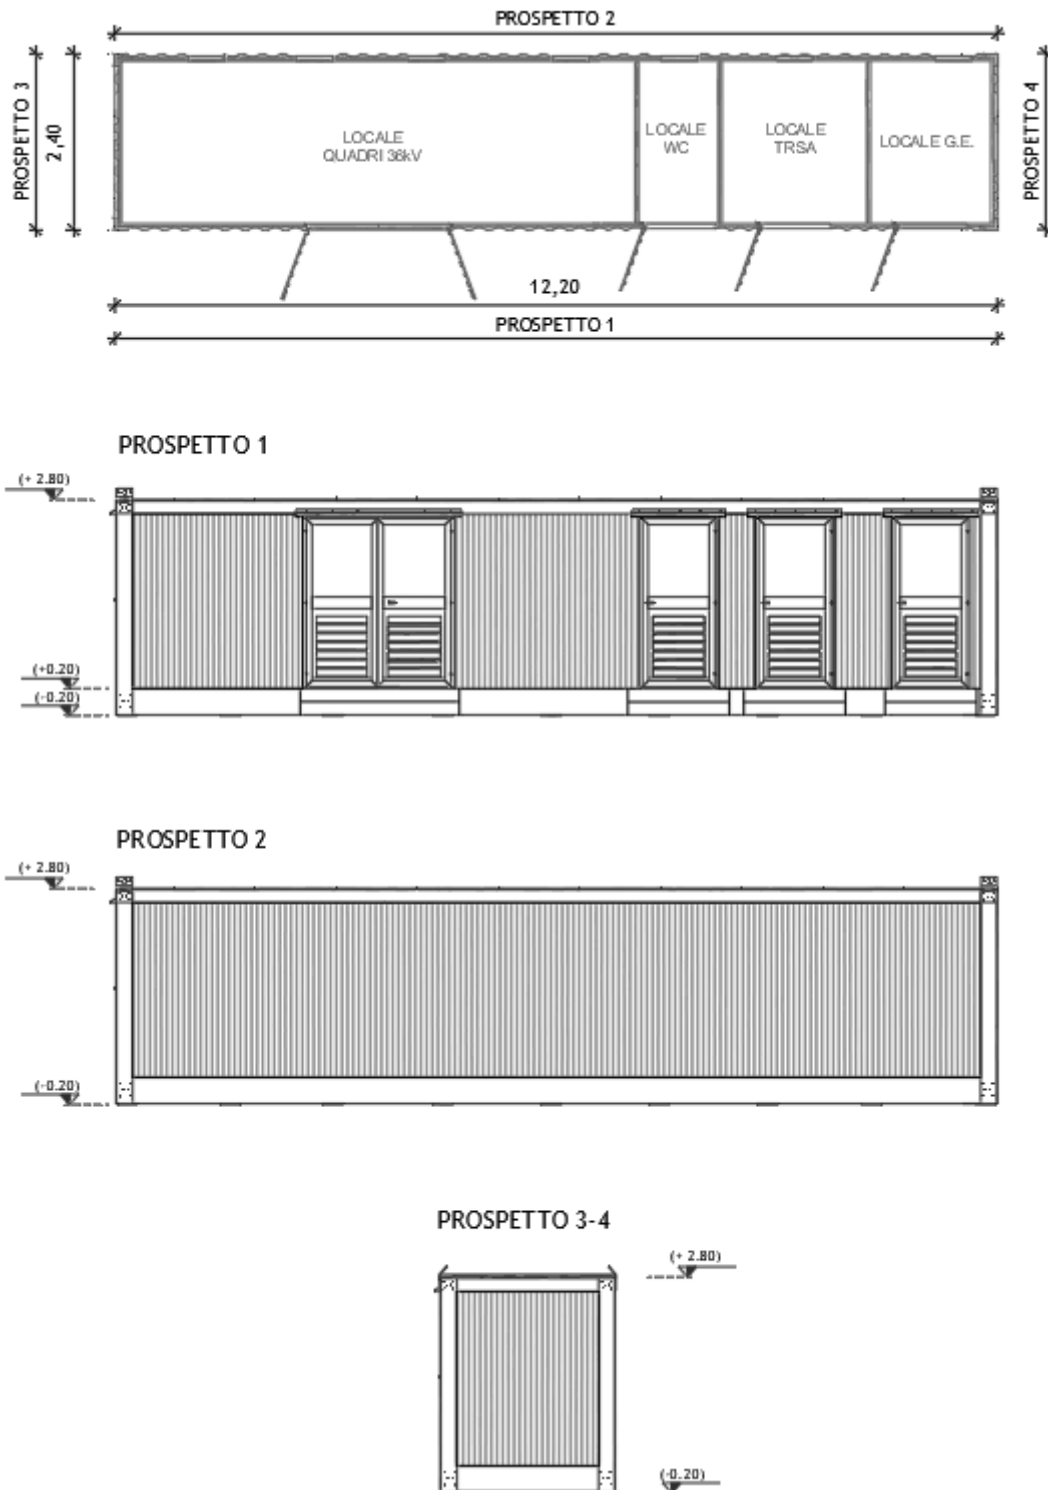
Pianta e prospetti dell'edificio quadri della cabina di consegna
